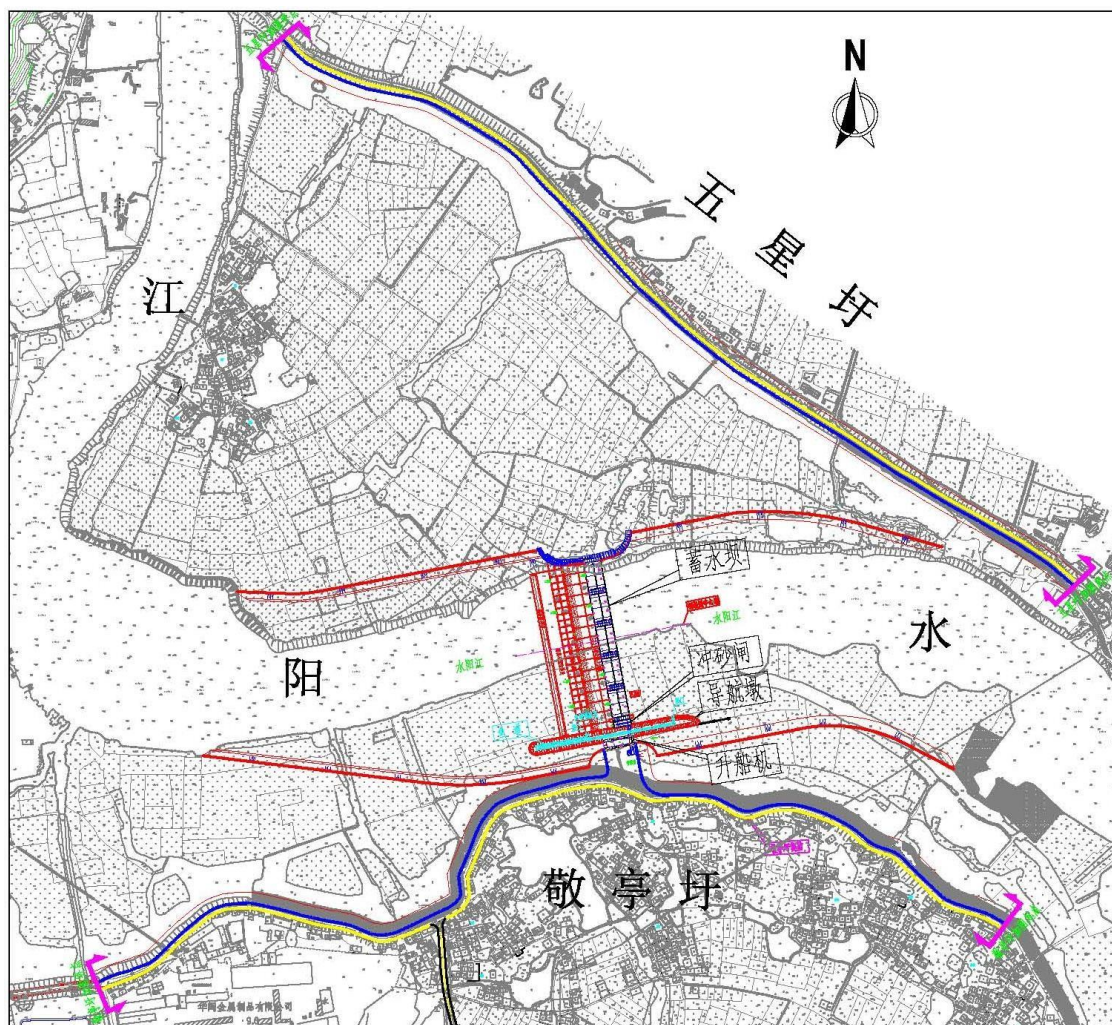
海棠湾枢纽工程上下游河道平面图
